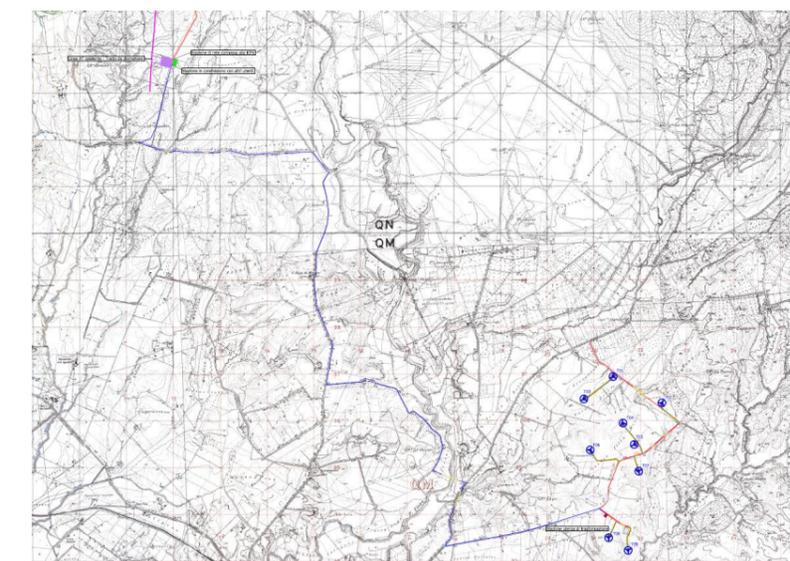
Inquadramento layout d'impianto comprensivo delle opere connesse e di connessione
